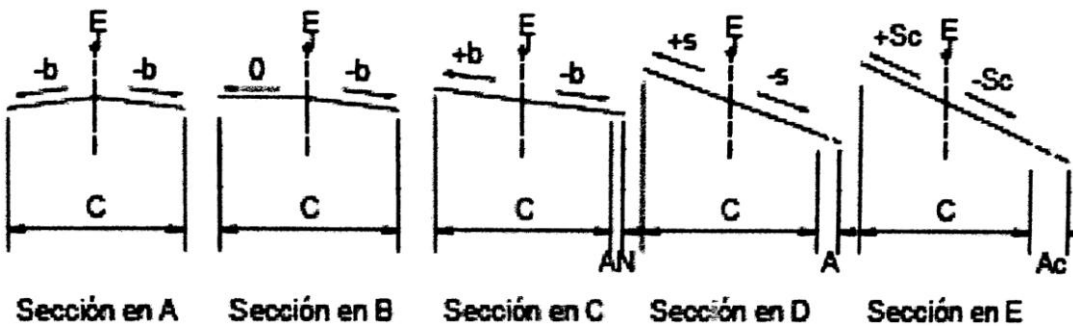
Desarrollo de la sobreelevación y la ampliación
